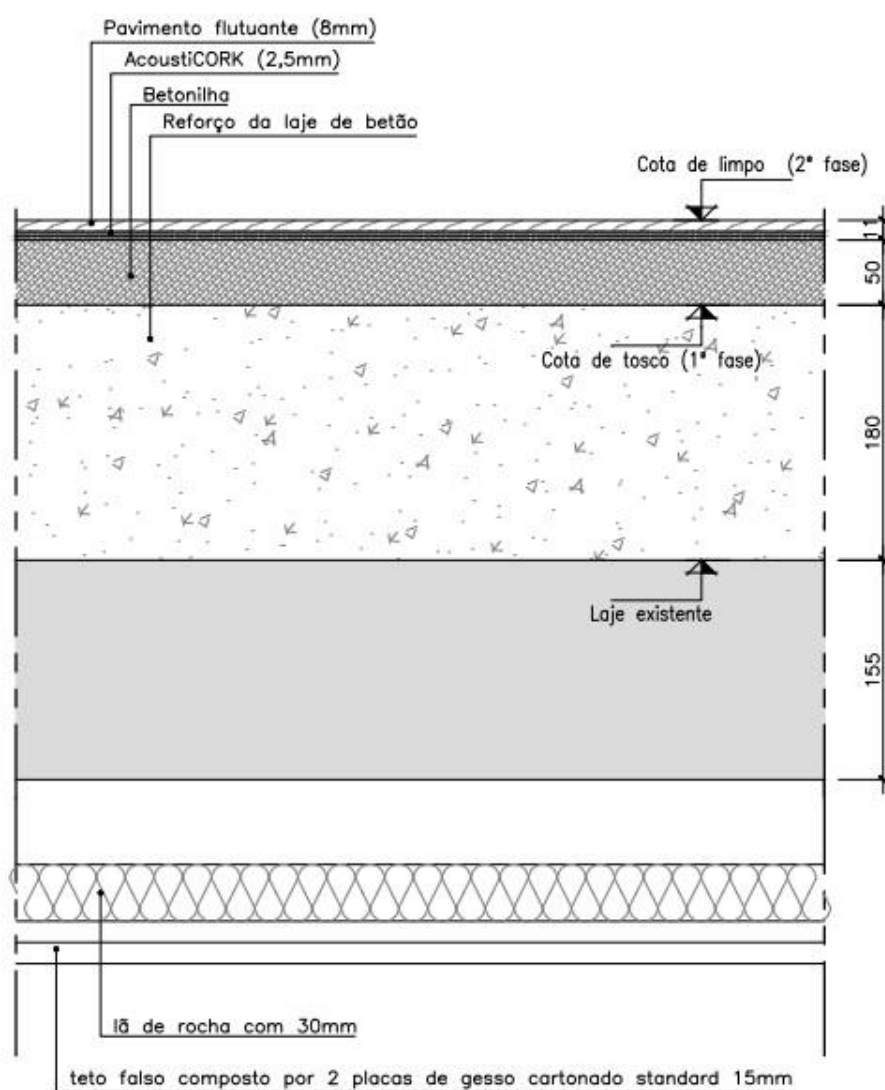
Pormenor do pavimento e do teto falso nos quartos e nas salas
